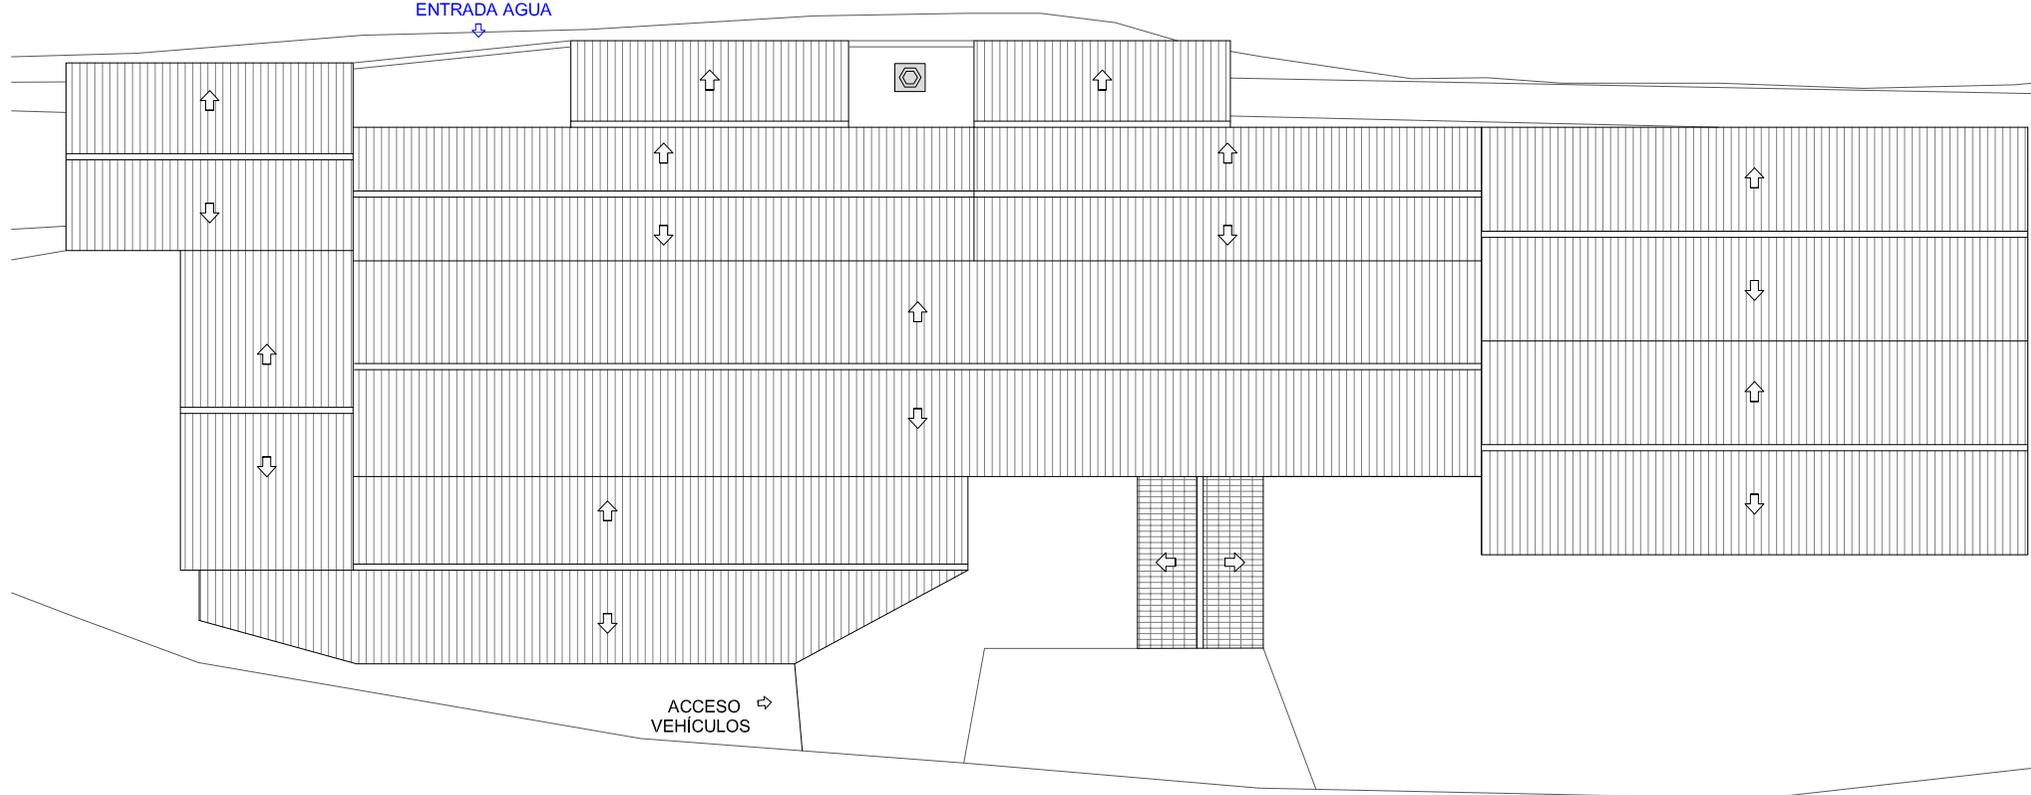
FOTO ESTADO ACTUALESQUEMA DE PLANTA
